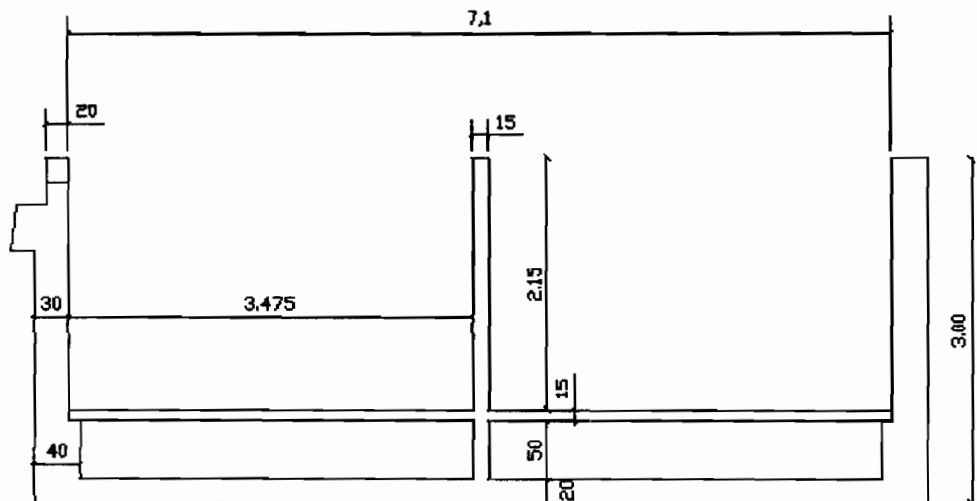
coupe longitudinale du bassin de filtration coupe longitudinale
